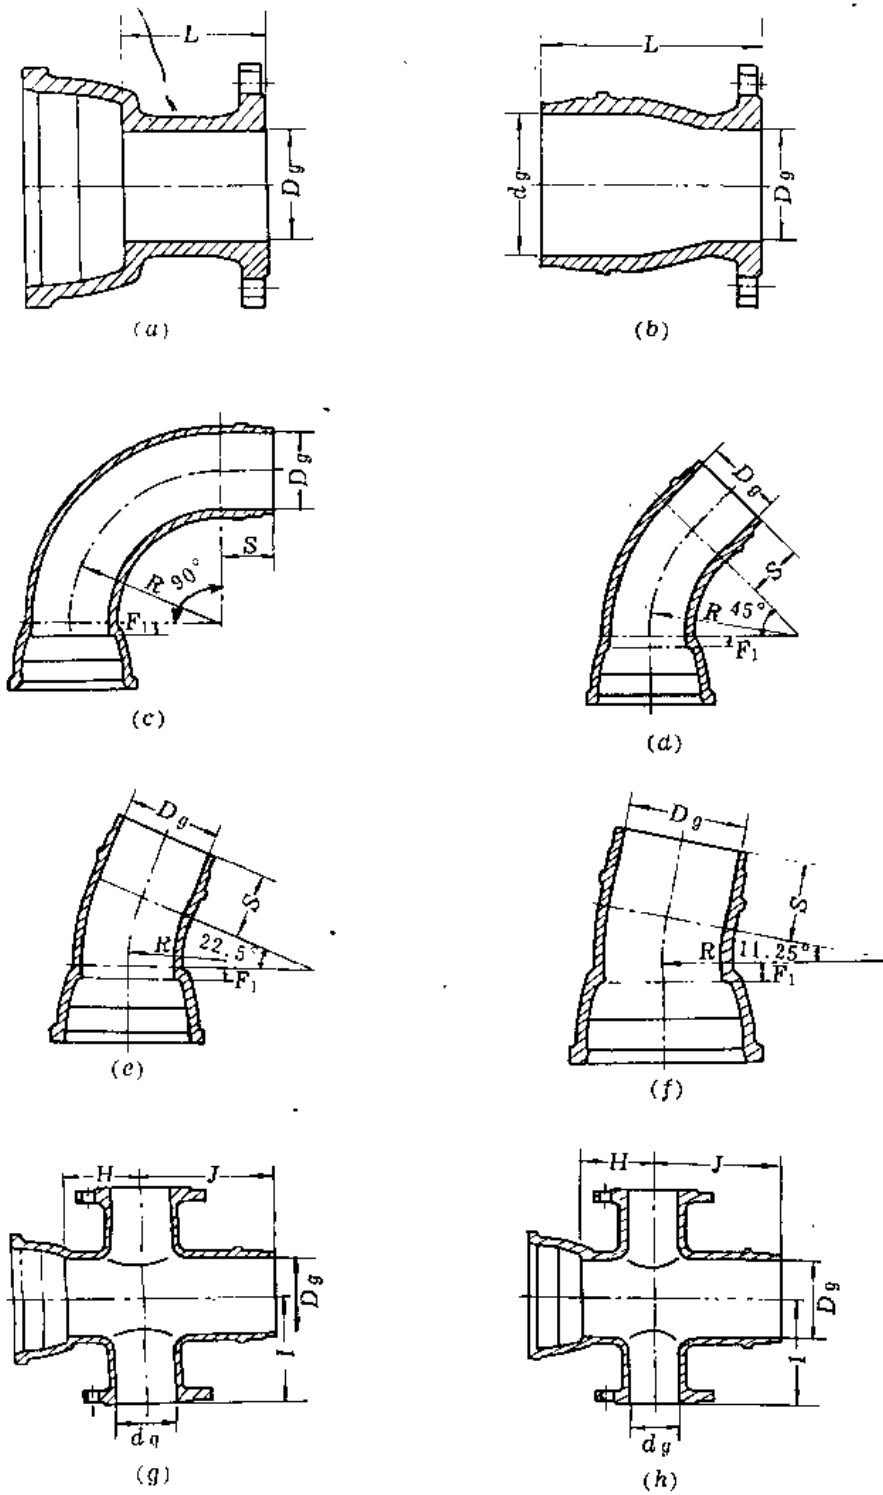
自应力钢筋混凝土管铸铁管件(一)
